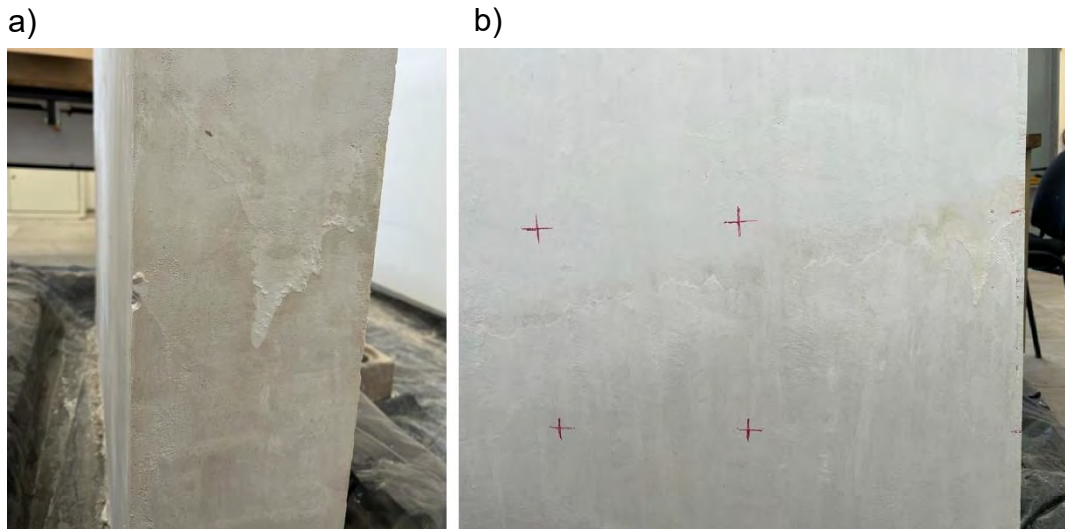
Eflorescencias presentes en el muro 1, a) lateral derecho, b) eflorescencia ascendente. Imagen del autor.
